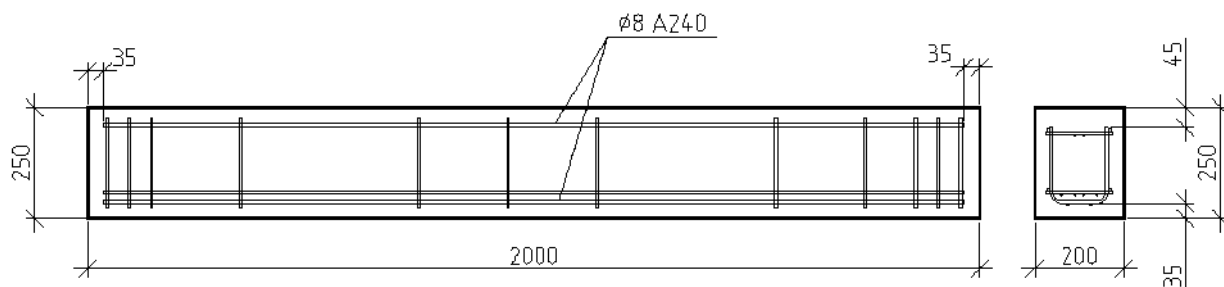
Схема армирования перемычки с объемным каркасом
